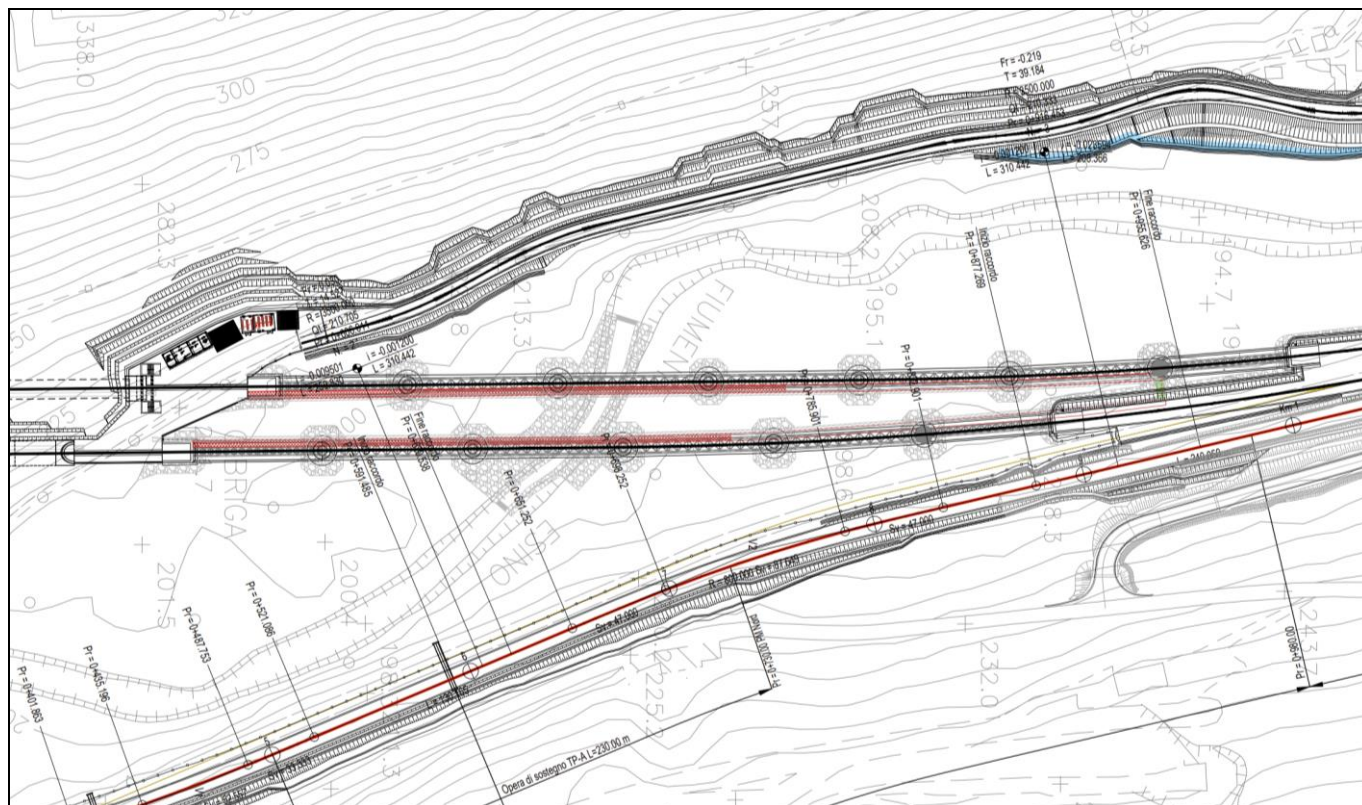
Viadotto VI01 (lotto 1): stralcio della planimetria di progetto.
